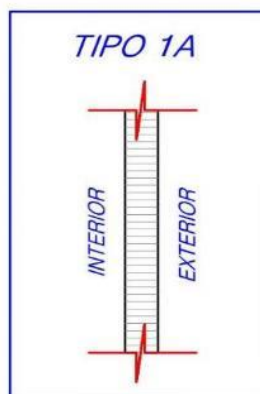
Envolvente tipo 1A muro vertical ángulo recto.
